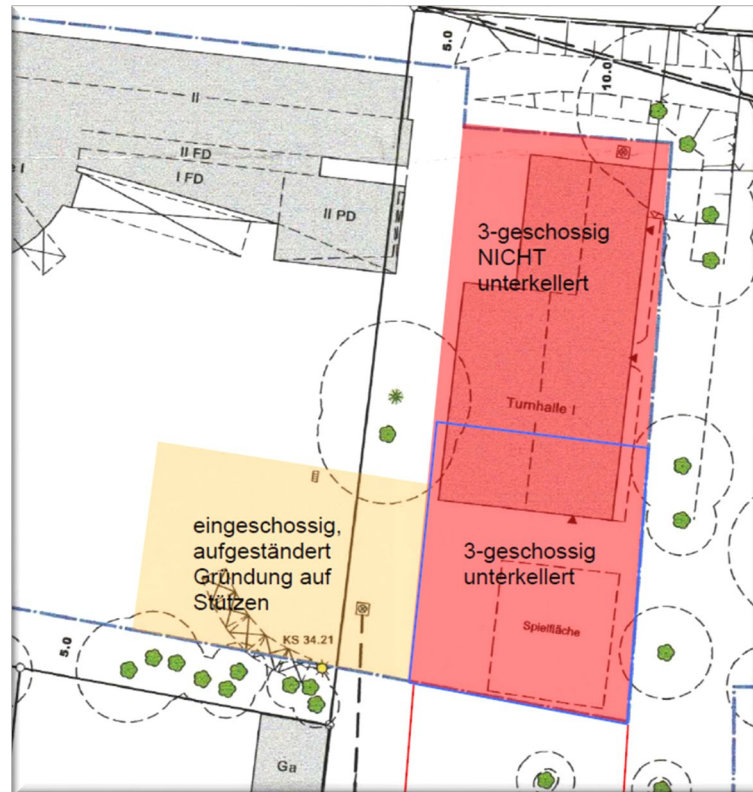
Lageplan des geplanten Gebäudes (ohne Maßstab,
